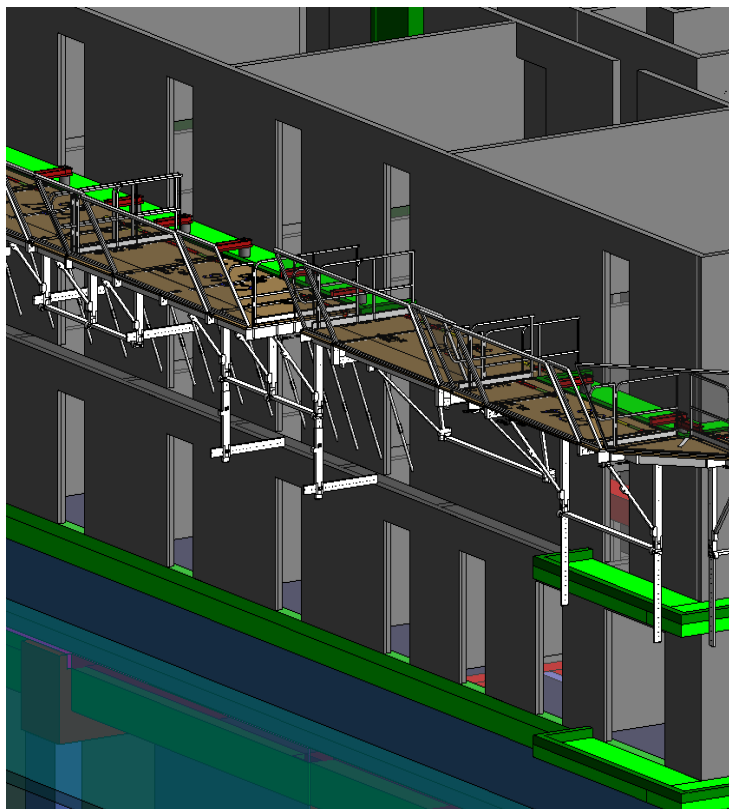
Exemple de famille d'échafaudage en 3D [28]
